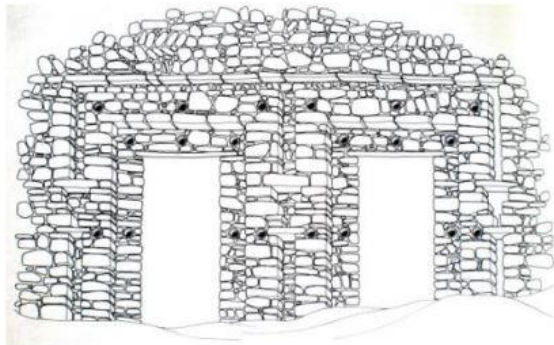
Muro mampostería de vivienda tipo en ciudades caravaneras
